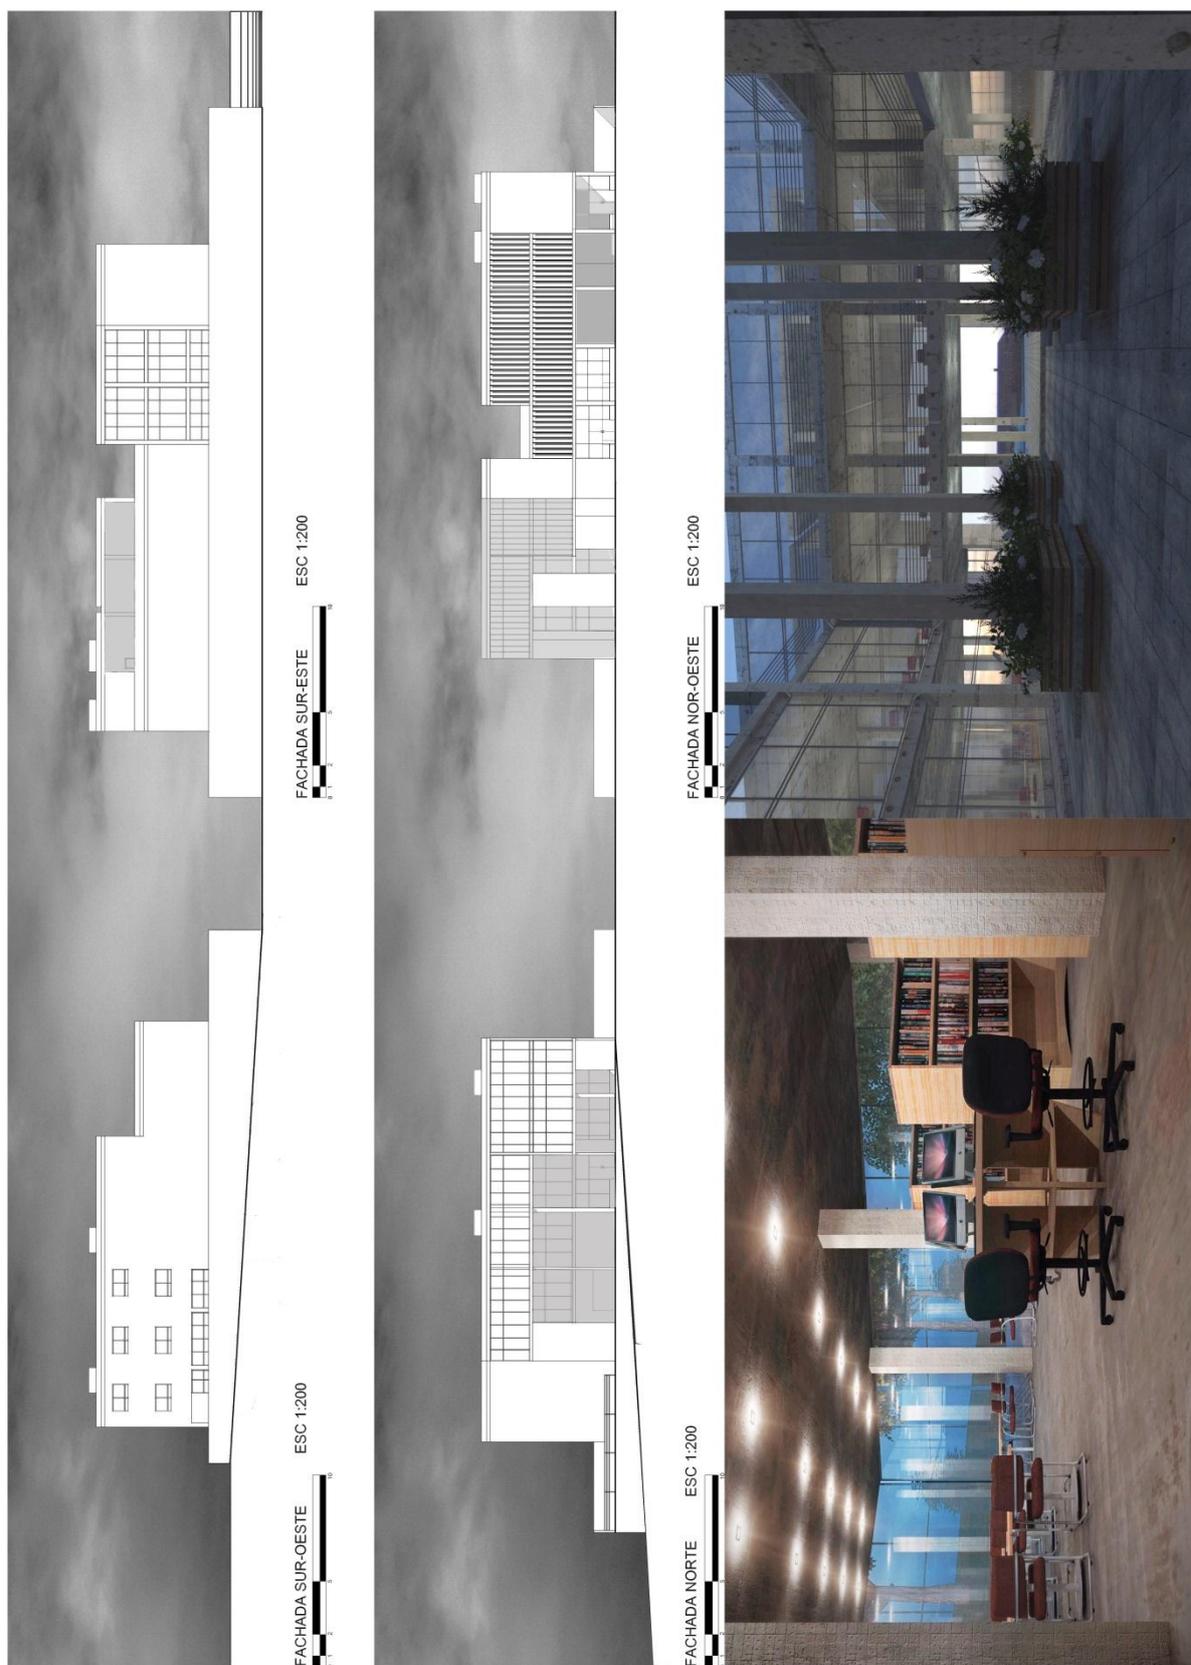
Fachadas y Vistas Biblioteca y Patio Central. Elaboración Propia.
